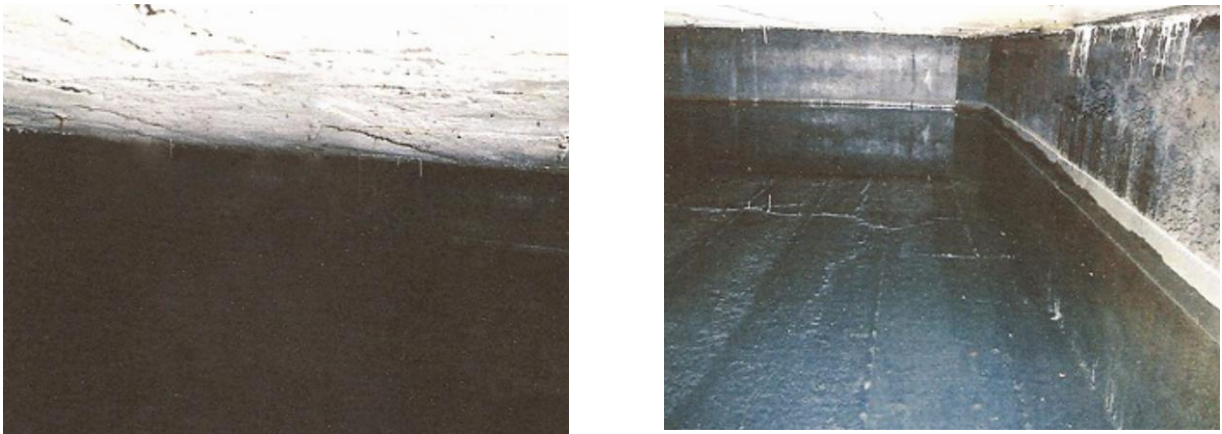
4.9 – Corrosão e infiltrações – Bloco C.
